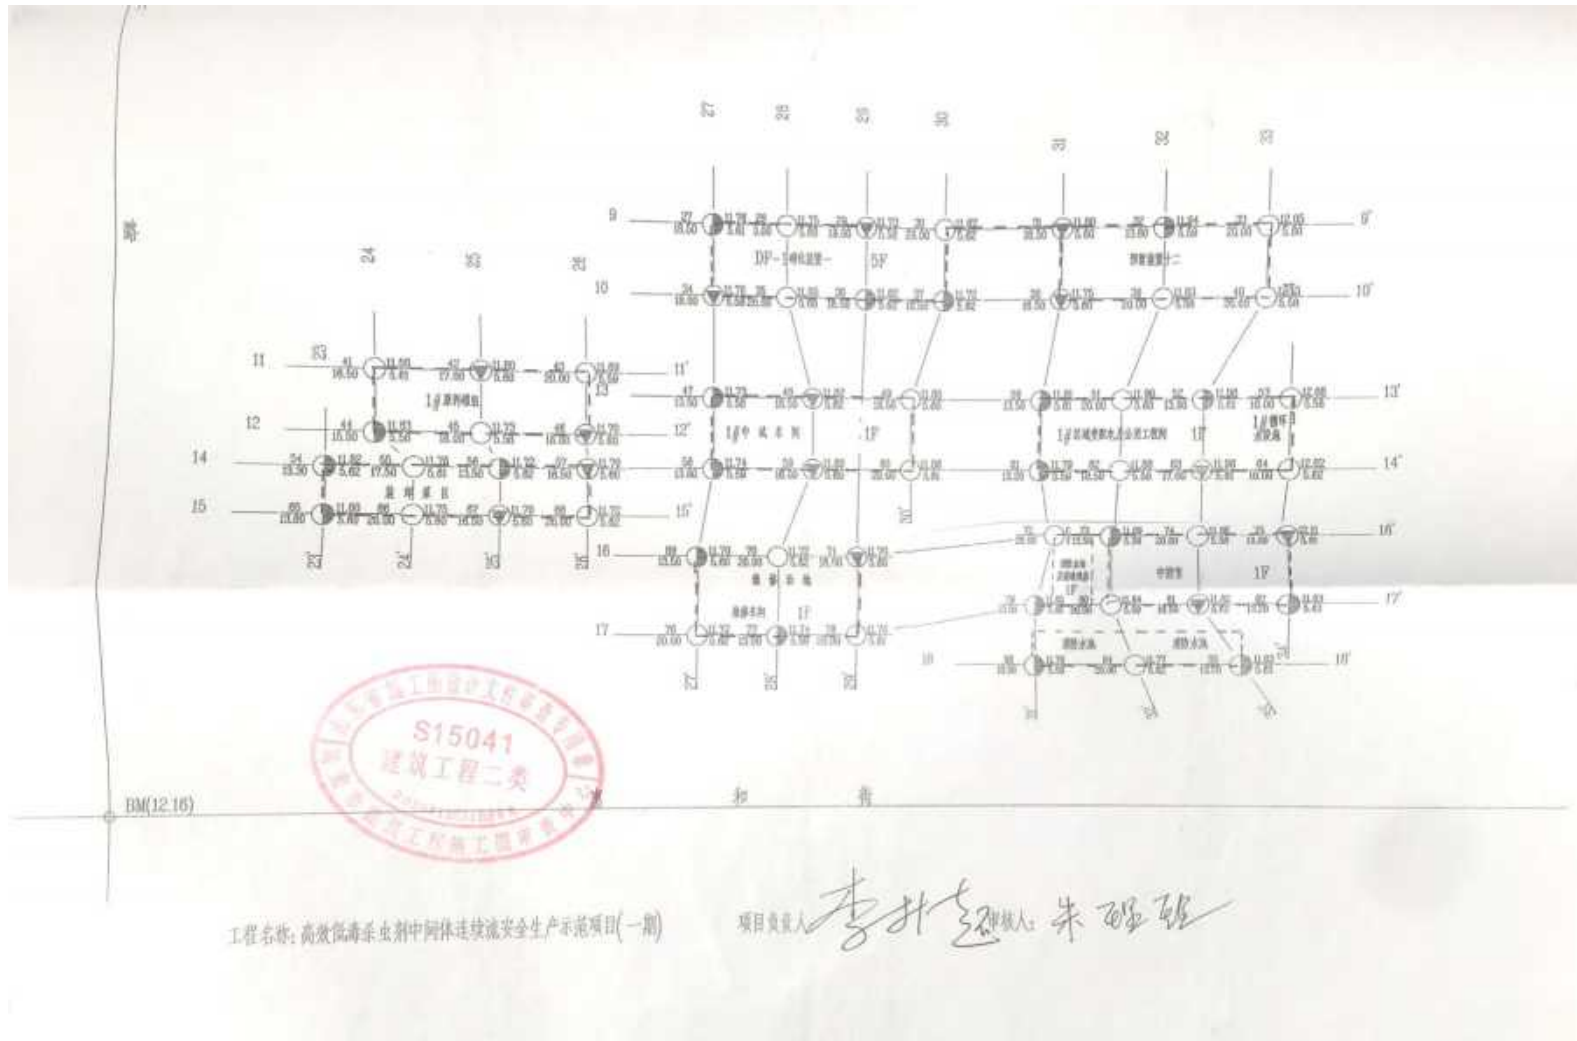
山东友道化学有限公司厂区勘探点平面布置图
